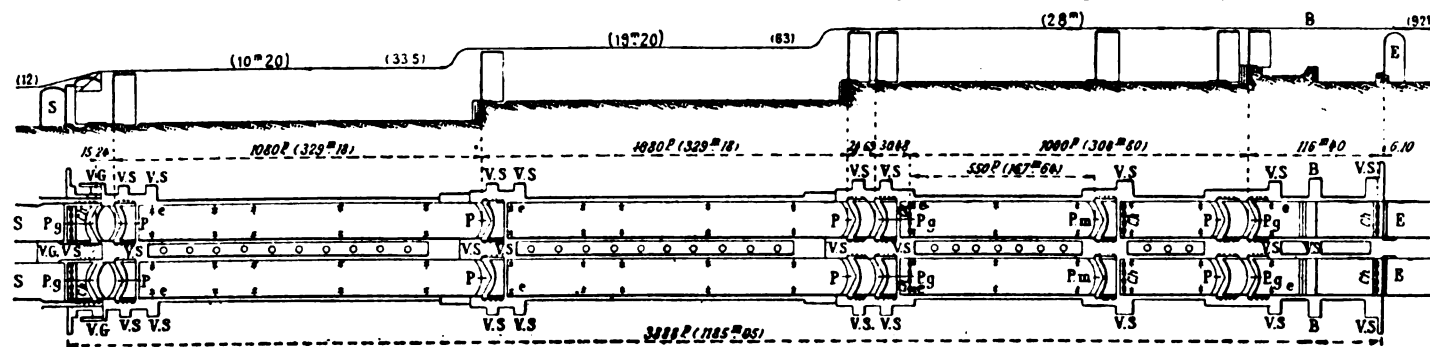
Profilo longitudinale e pianta delle chiusure di Gatun con l'indicazione dell'impianto dei vari meccanismi.
